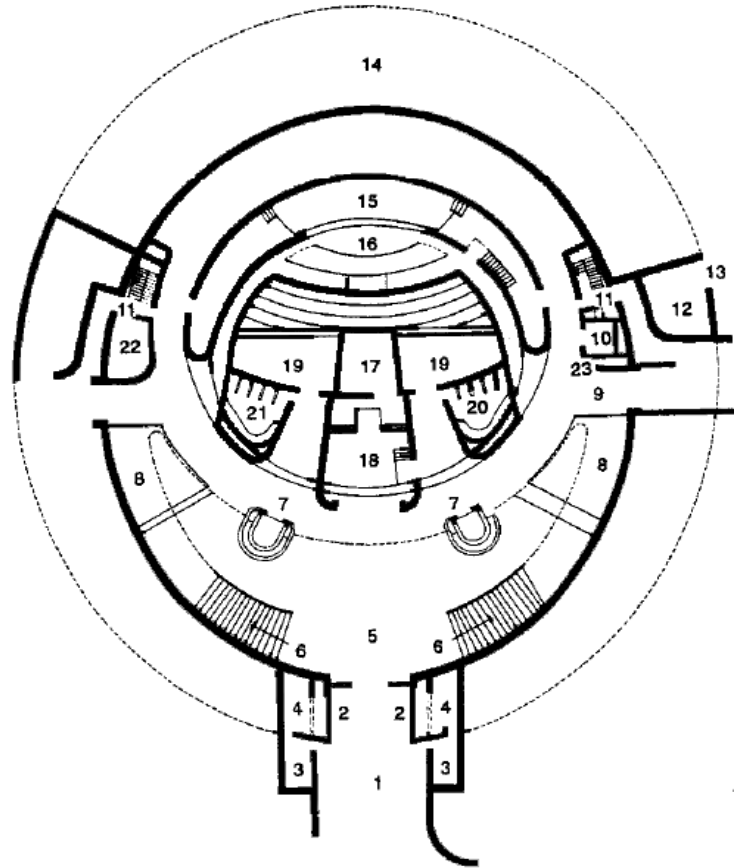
Lobby centro cultural alfa planta arquitectónica.
